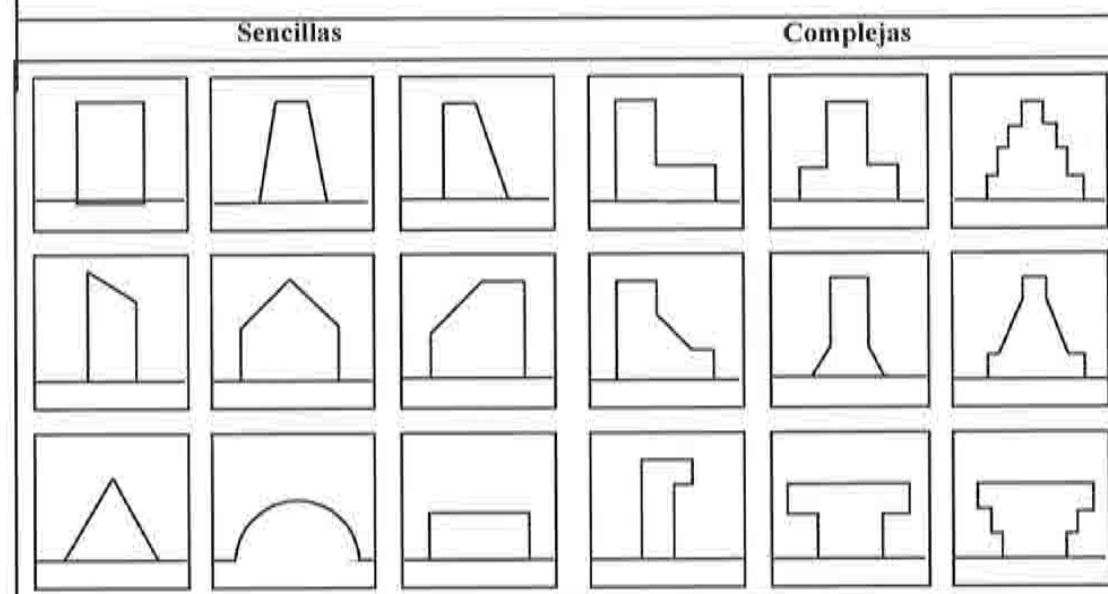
FORMAS SENCILLAS Y COMPLEJAS EN PLANTA Y ELEVACION
